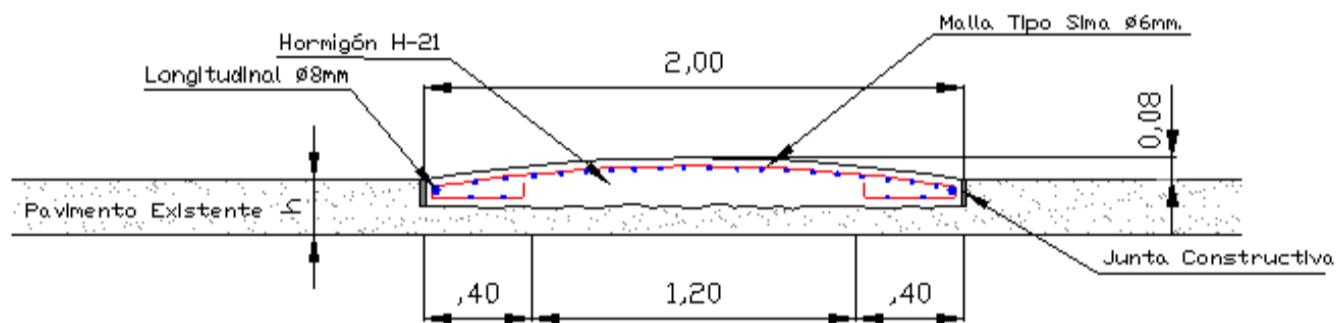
Demolición y Ejecución de Hormigón Armado
